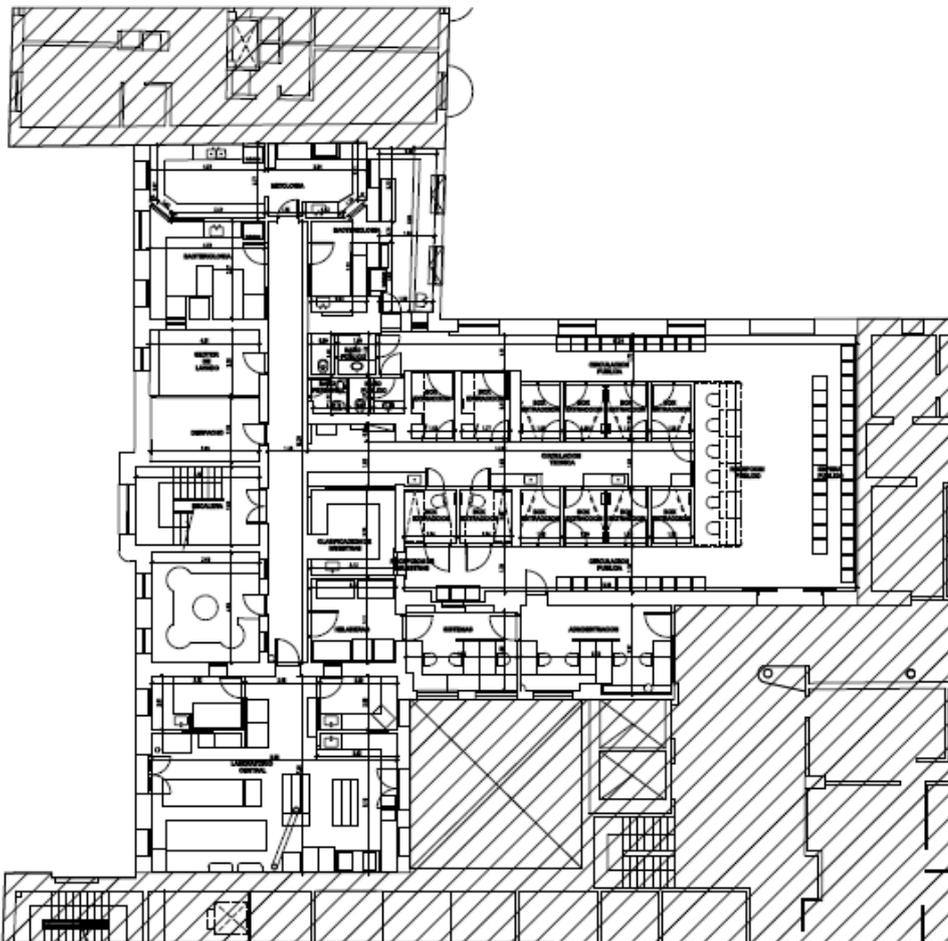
Planos de las instalaciones del Hospital Alemán. Escala 1:100. Fuente: Laboratorio Domecq & Lafage
